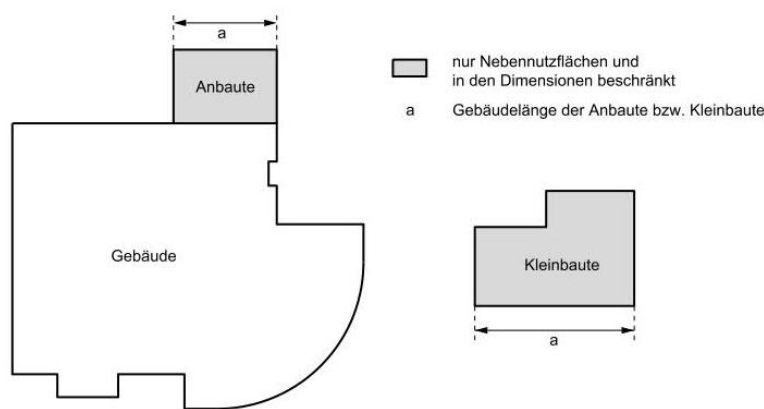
Figur 2.1 - 2.3 Gebäude, Kleinbauten und Anbauten, IVHB
